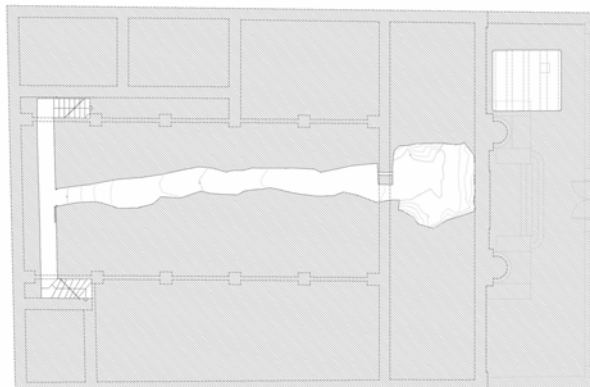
Planta de la Sala de Reflexión, bajo el edificio y su acceso, aljibe y esquema de estructura.
